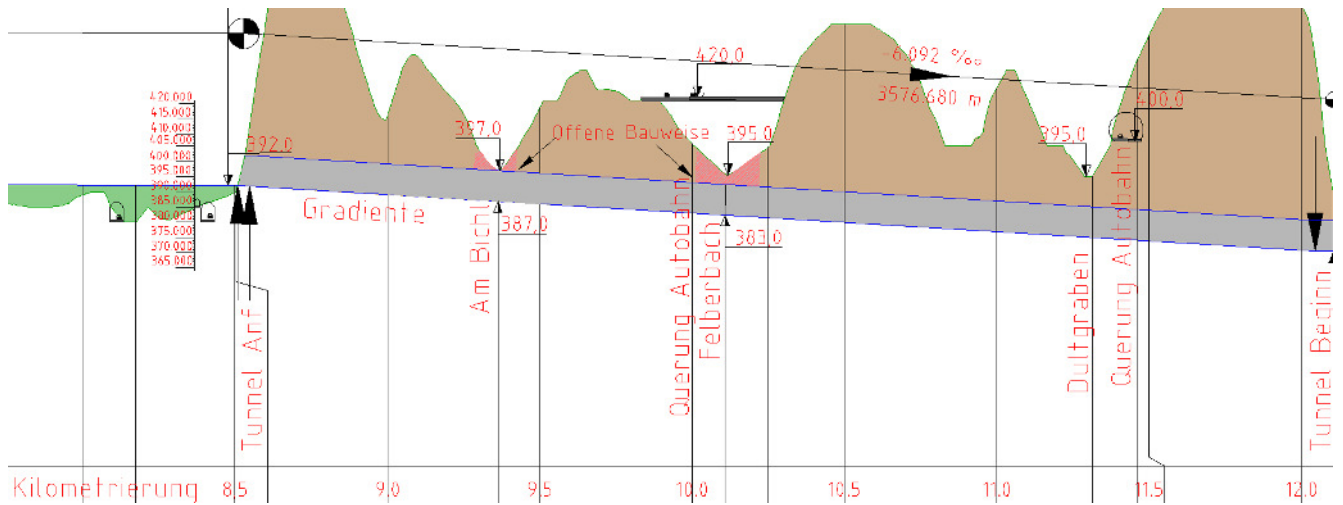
Längsschnitt Tunnel Gratkorn Variante Plabutsch
